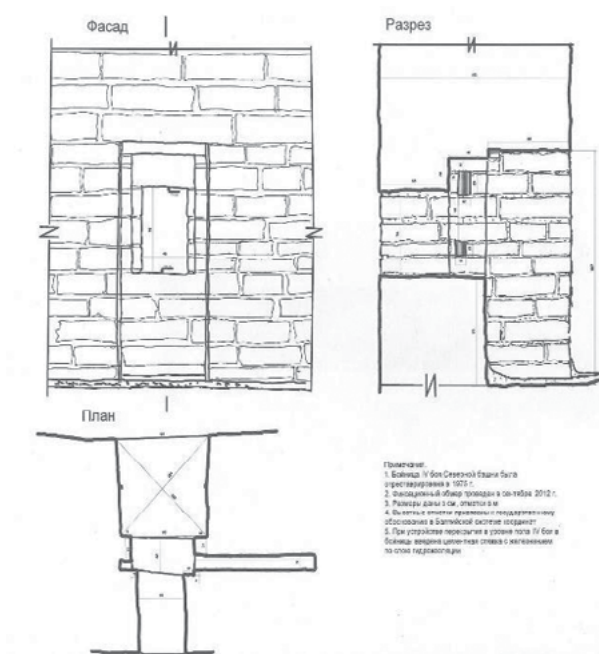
Бойница IV яруса Северной башни. (обмерные чертежи и фото)
